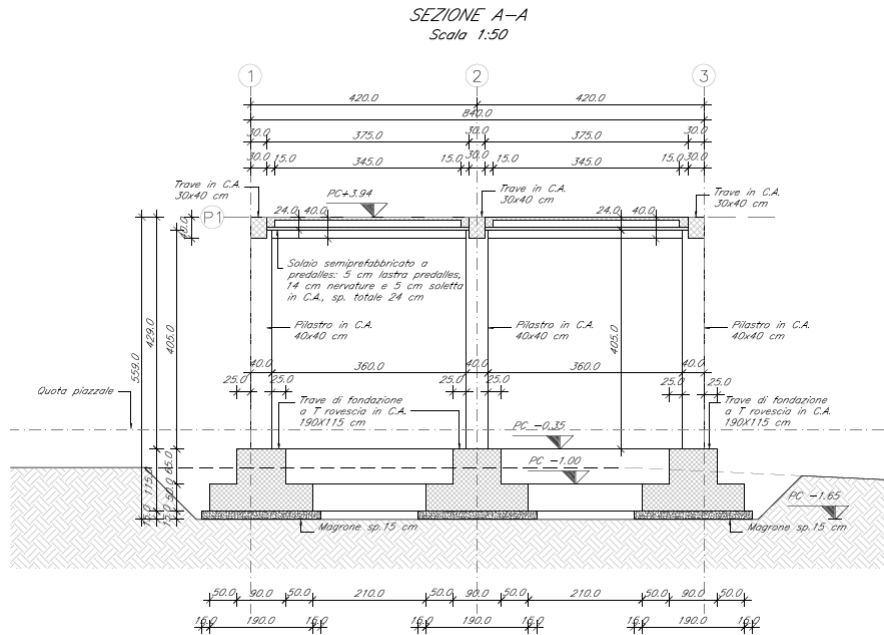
Sezione Longitudinale – Locale consegna
